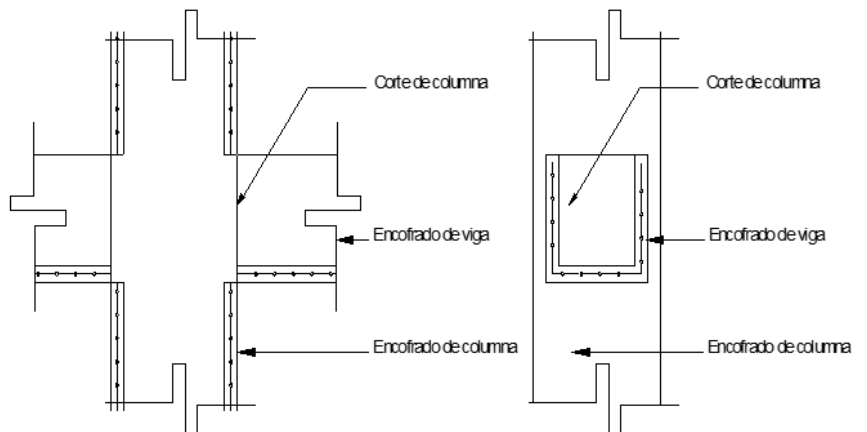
Unión de encofrados de cadenas y columnas (Corte y vista frontal)
